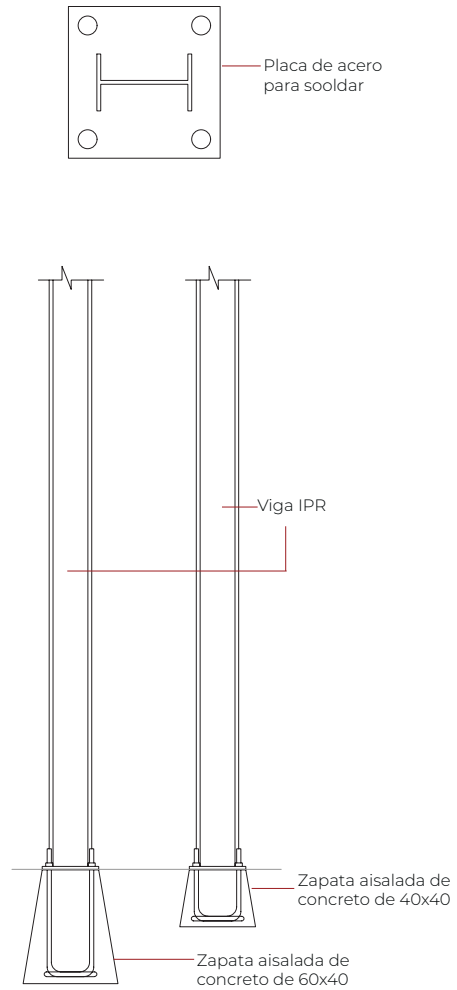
Detalle constructivo de anclaje en escalera exterior.
